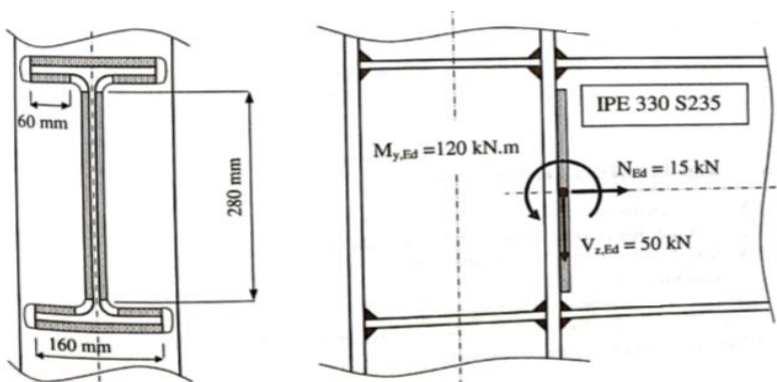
Assemblage soudé (poteau-traverse)
